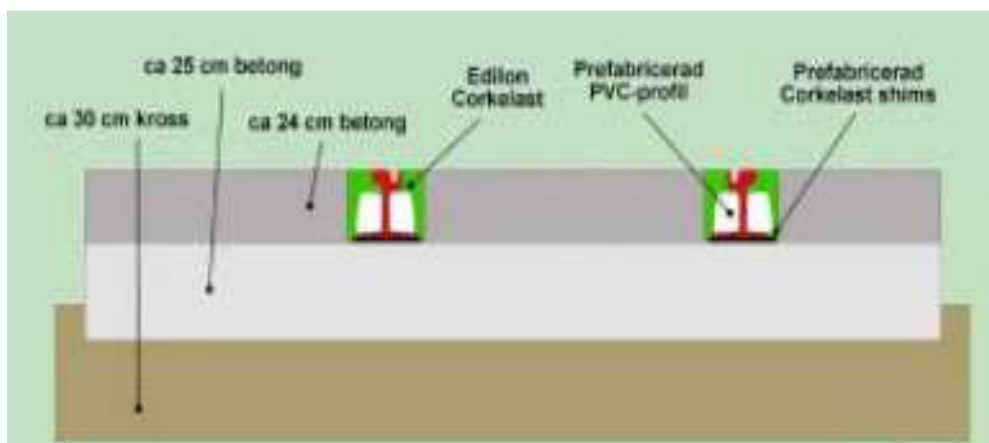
Principiell uppbyggnad av betongspår med betongöverbyggnad.
